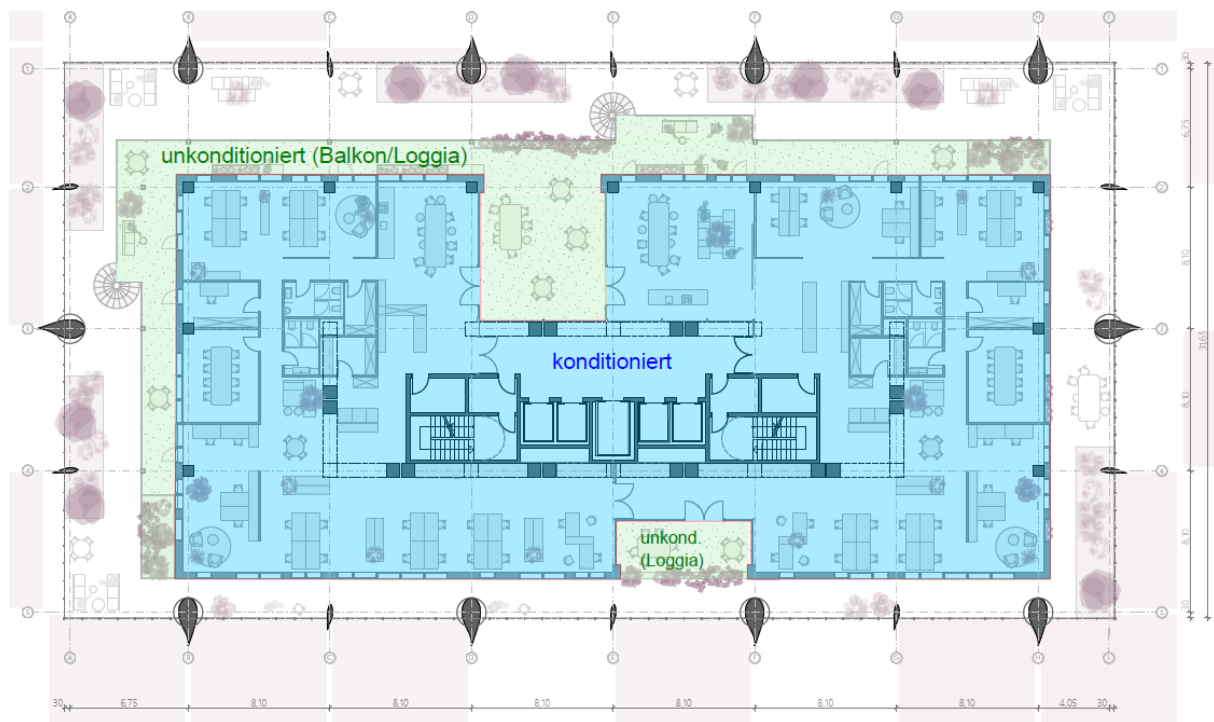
Grundriss Regelgeschoss, Quelle: Studentengruppe ISDEC2030 – konditionierte (blau) und unkonditionierte (grün) Bereiche der BGF
